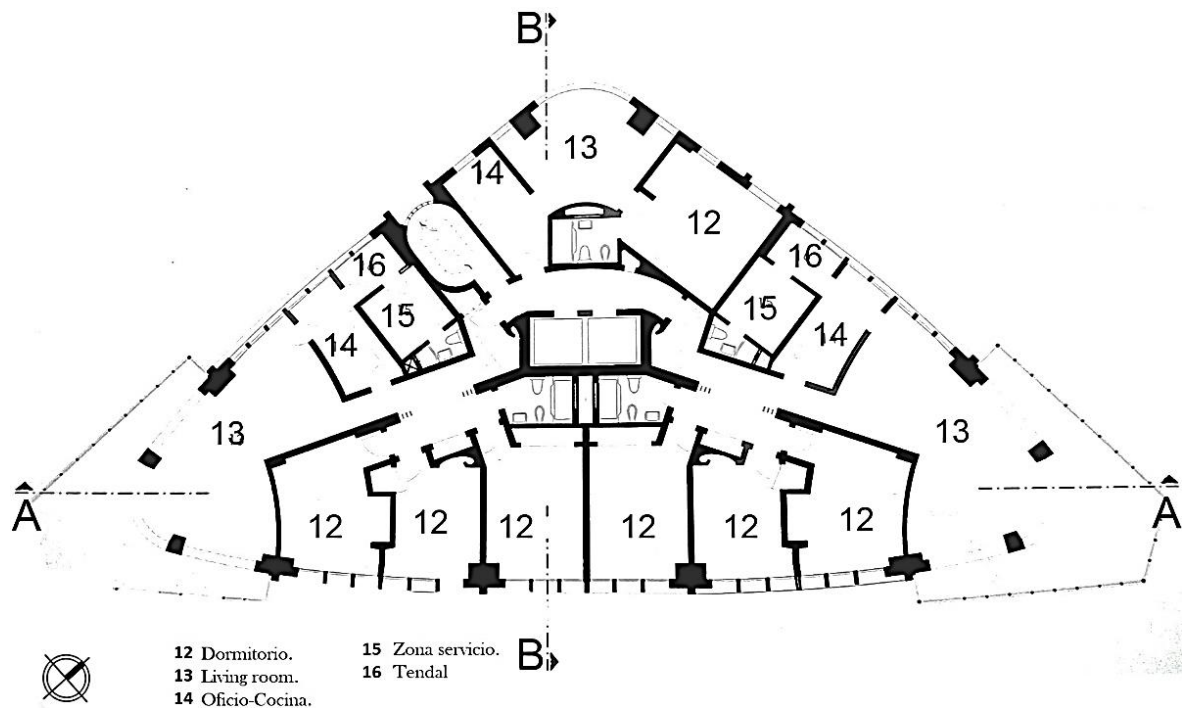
Planta típica del 4° al 8° nivel. Planta elaborada por Viccina (2015).
